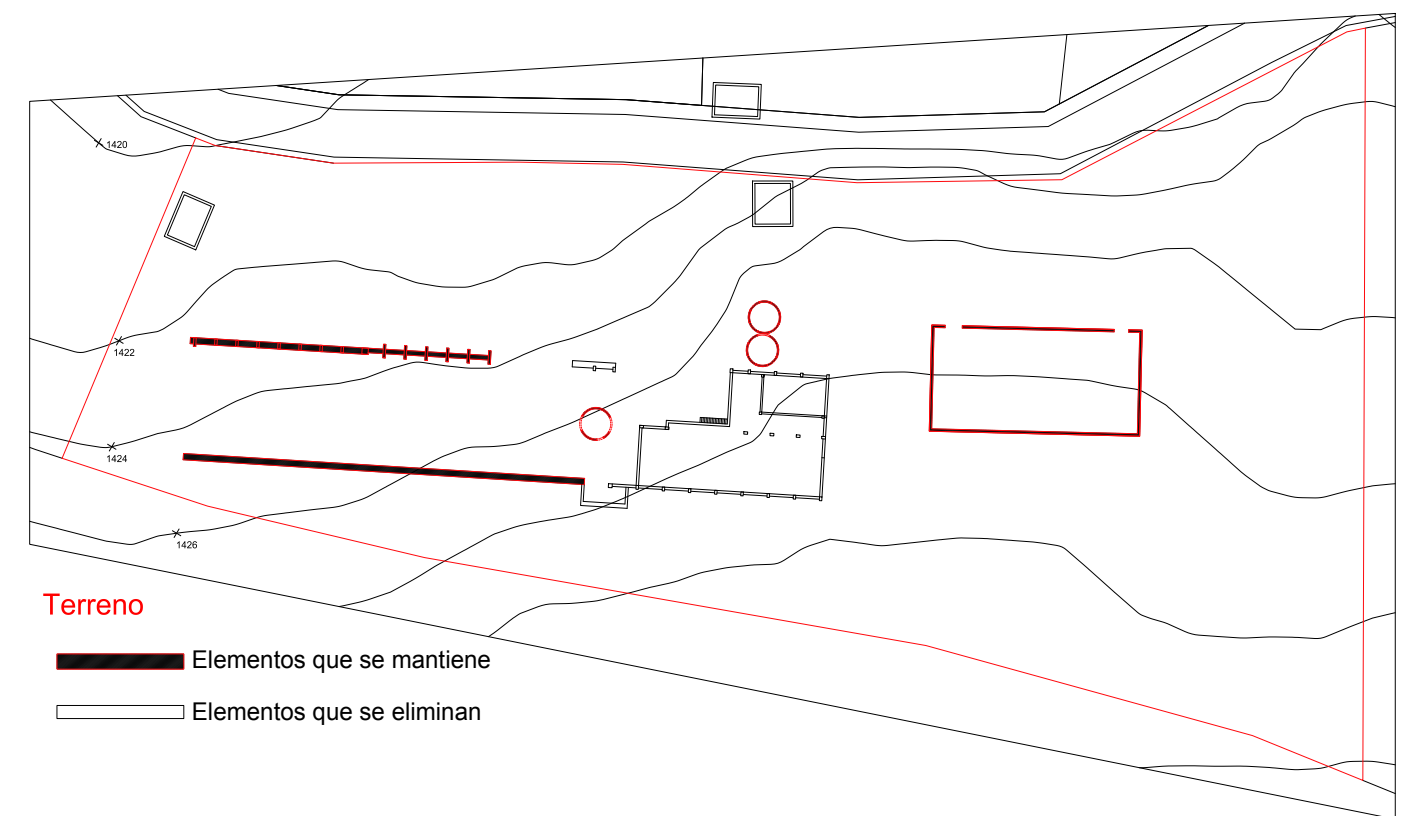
Planta de estructuras que se mantienen y se eliminan Fuente: Elaboración propia
